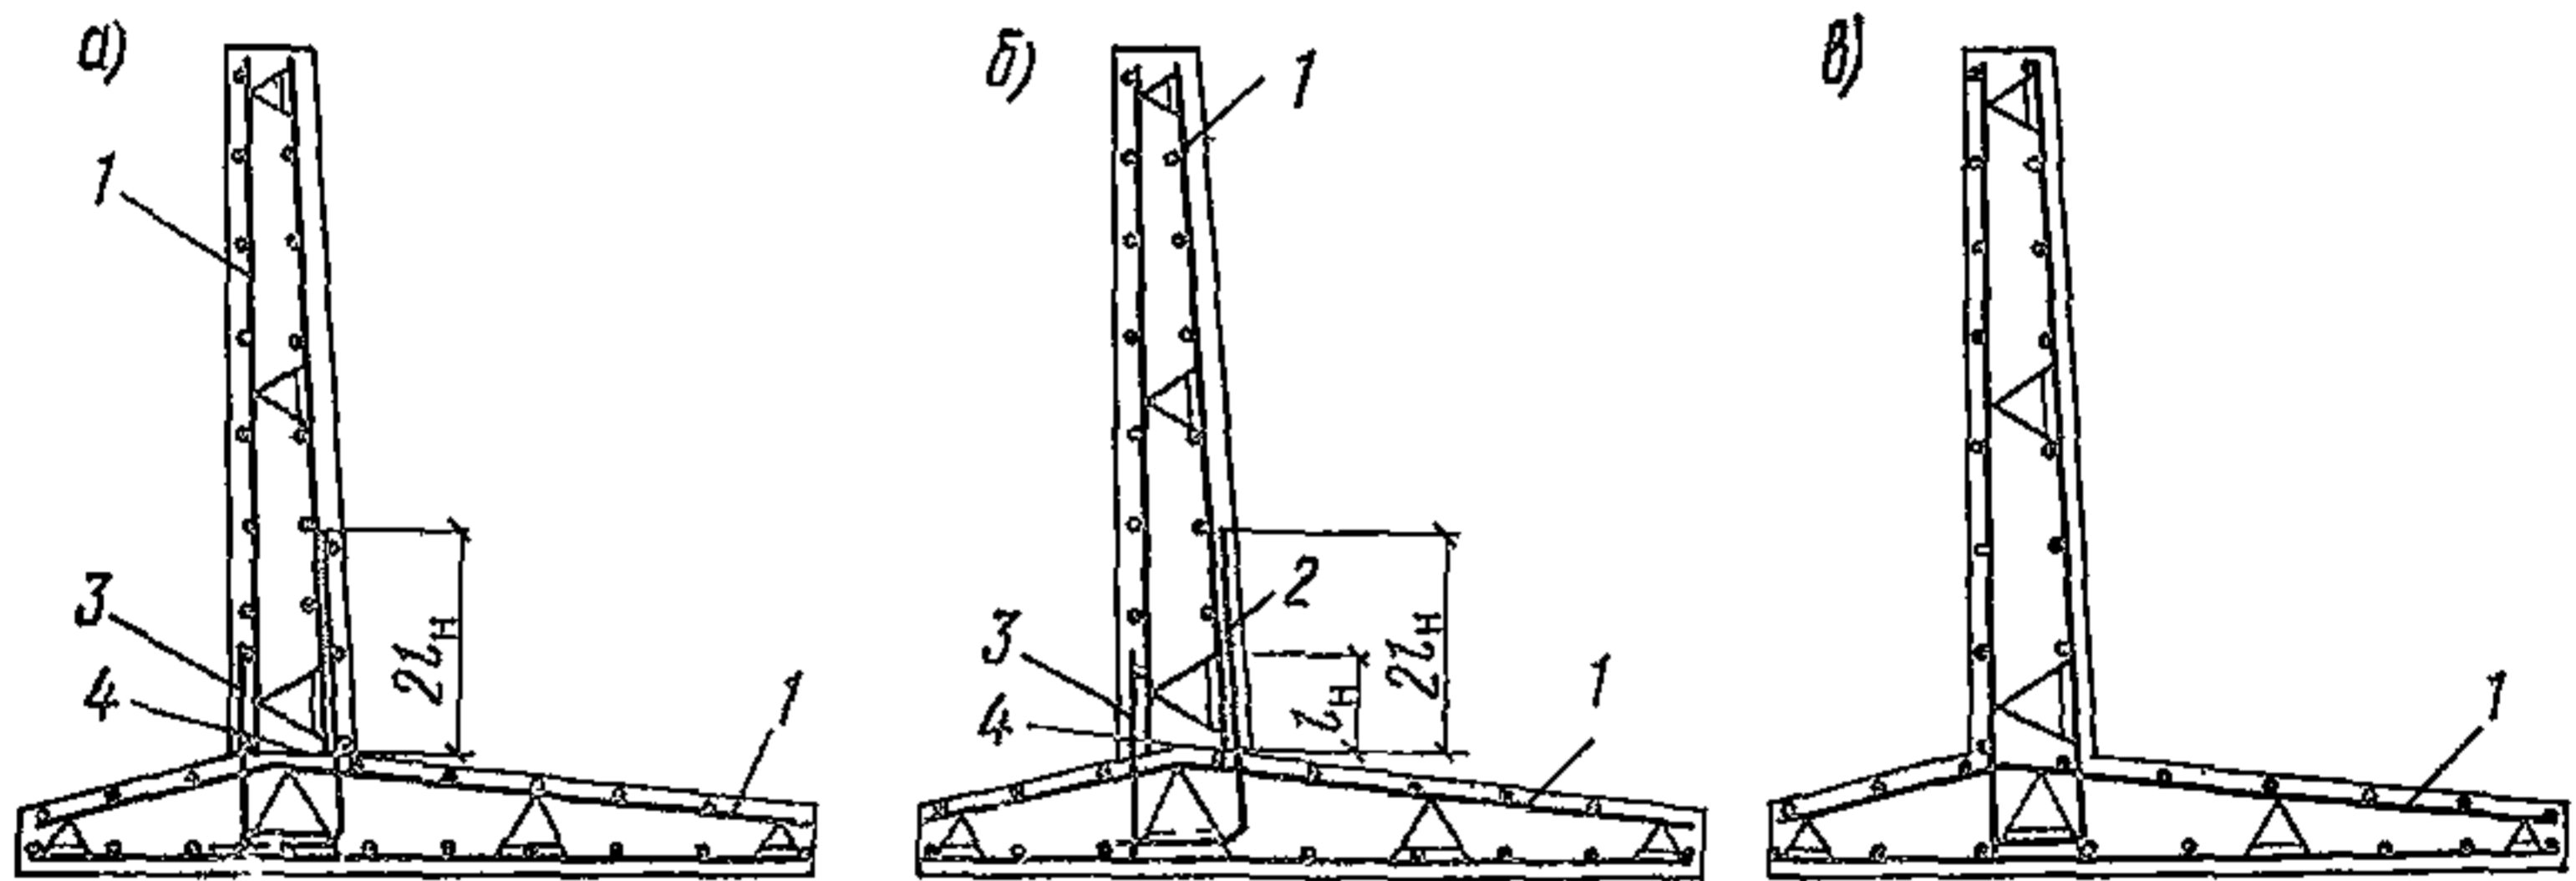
Армирование подпорных стенок самонесущими арматурными блоками
